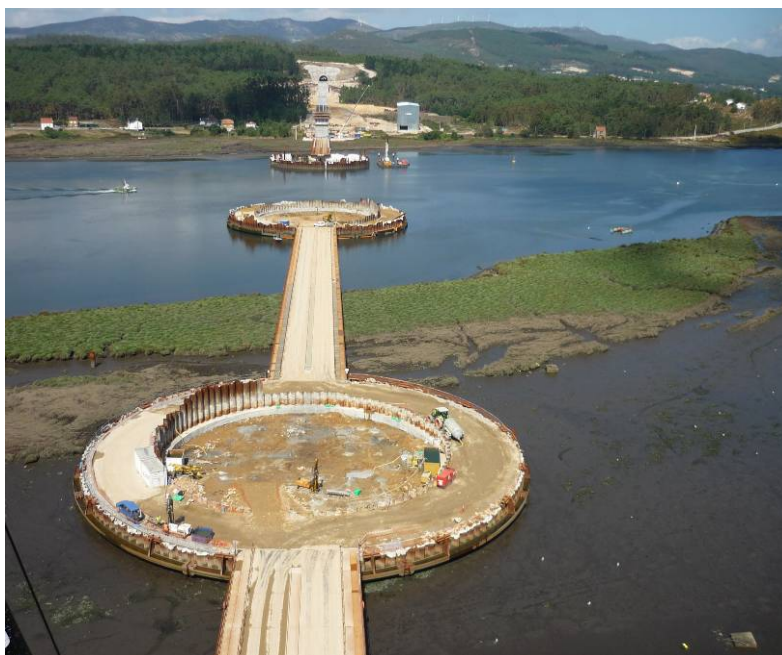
Vista general de las obras en la ría, pila 5 en primer término
